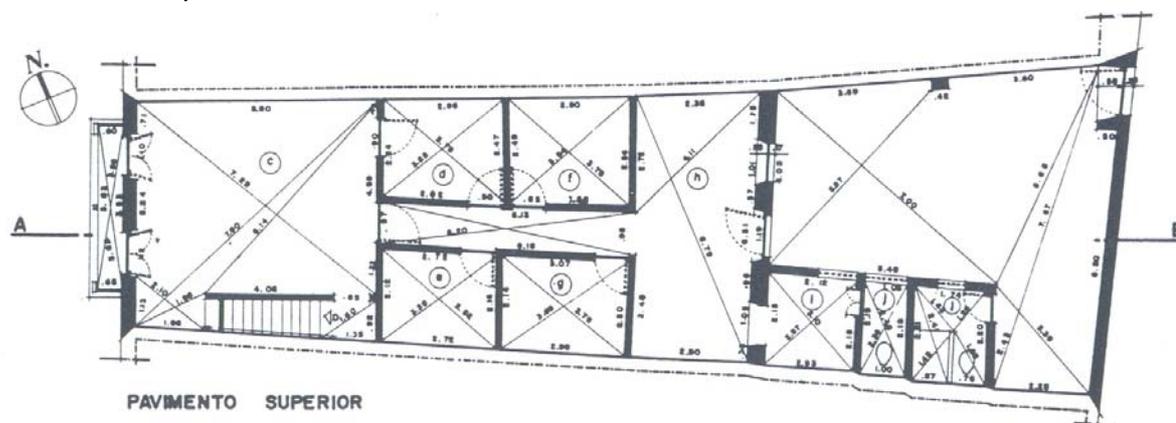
Exemplo de croqui de levantamento de planta baixa geral com triangulação por ambientes.
